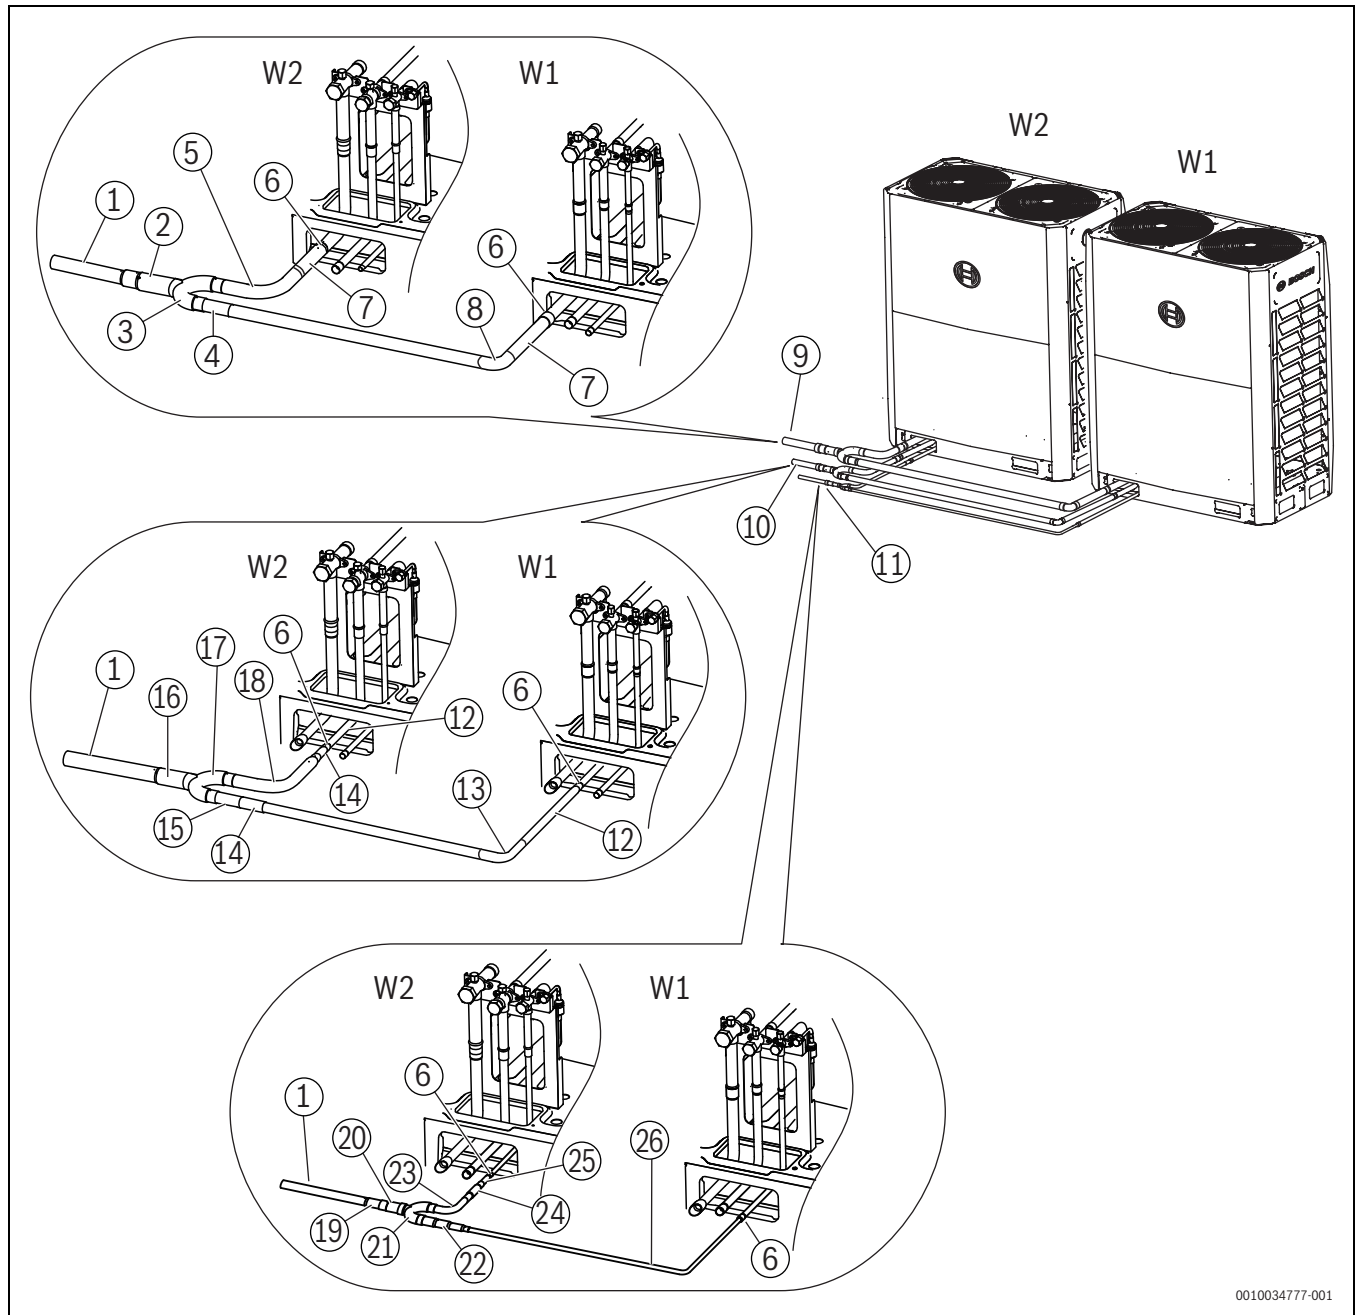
Внешний вид и схематический рисунок AF-BJRO 02
